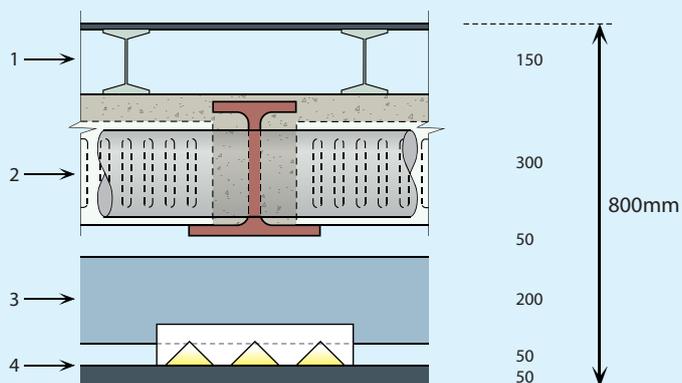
Типовая конструкция перекрытия с неравнополочными балками и плитой по профнастилу с высоким гофром
